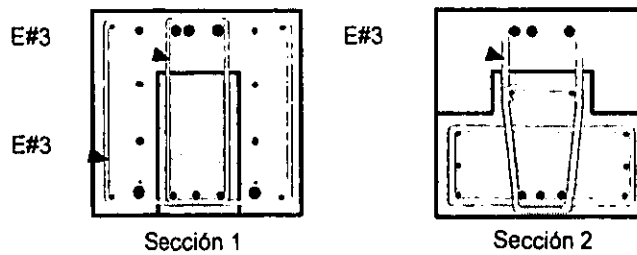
Refuerzo para fuerza cortante en las vigas portantes
